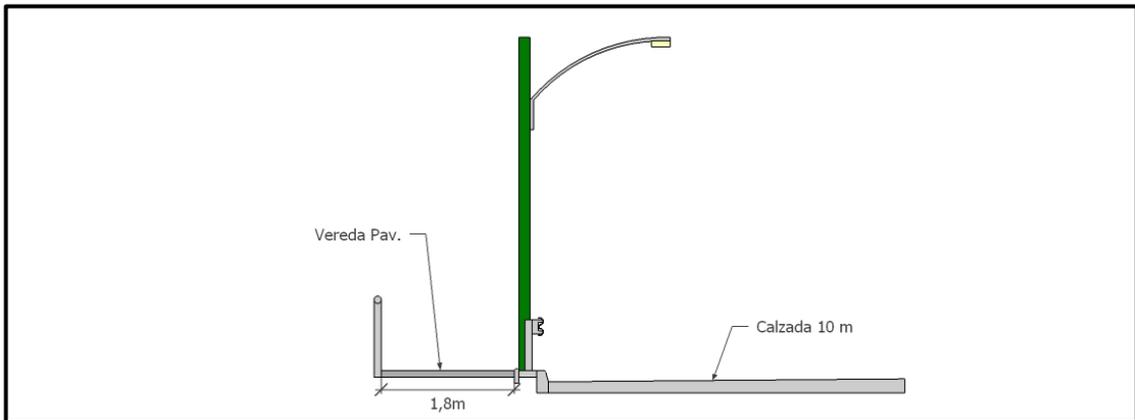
Perfil Transversal Eje A (Av. España) / Sector A1 / 2
